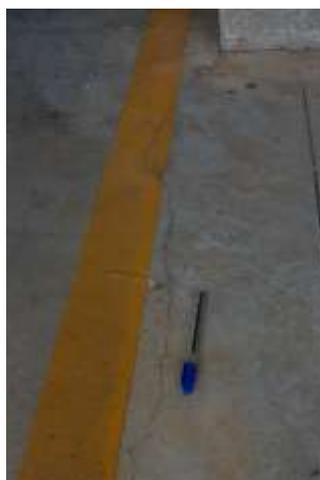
Fissura iniciando na extremidade do pilar
